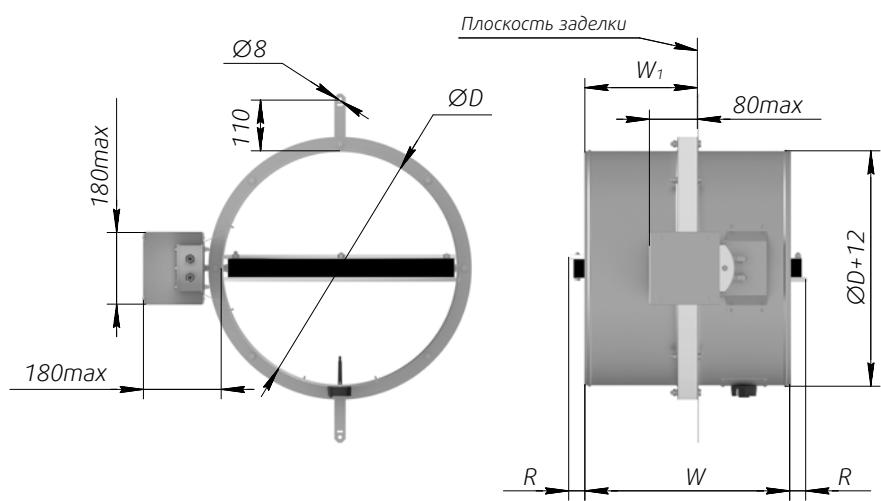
в. Размеры ниппельного клапана HELMER, EI90 (с возможностью стеновой заделки)
